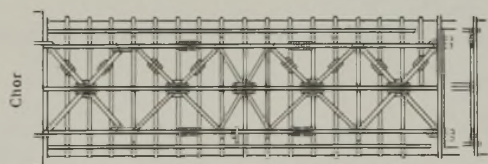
Waagrecht liegendes Holzfachwerk über dem Mittelschiff.
